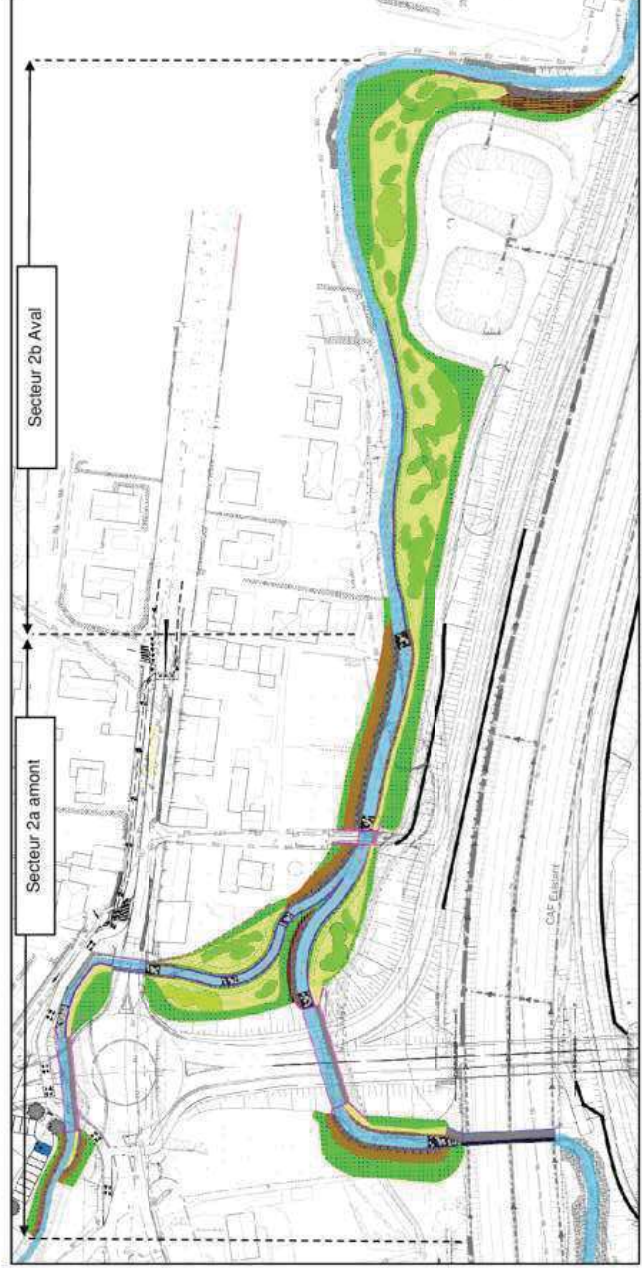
Vue en plan du déroulement de la deuxième phase chantier
